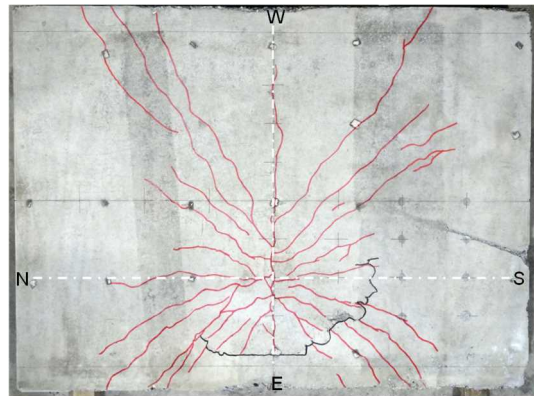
下面のひび割れ状況 (供試体 SF)
